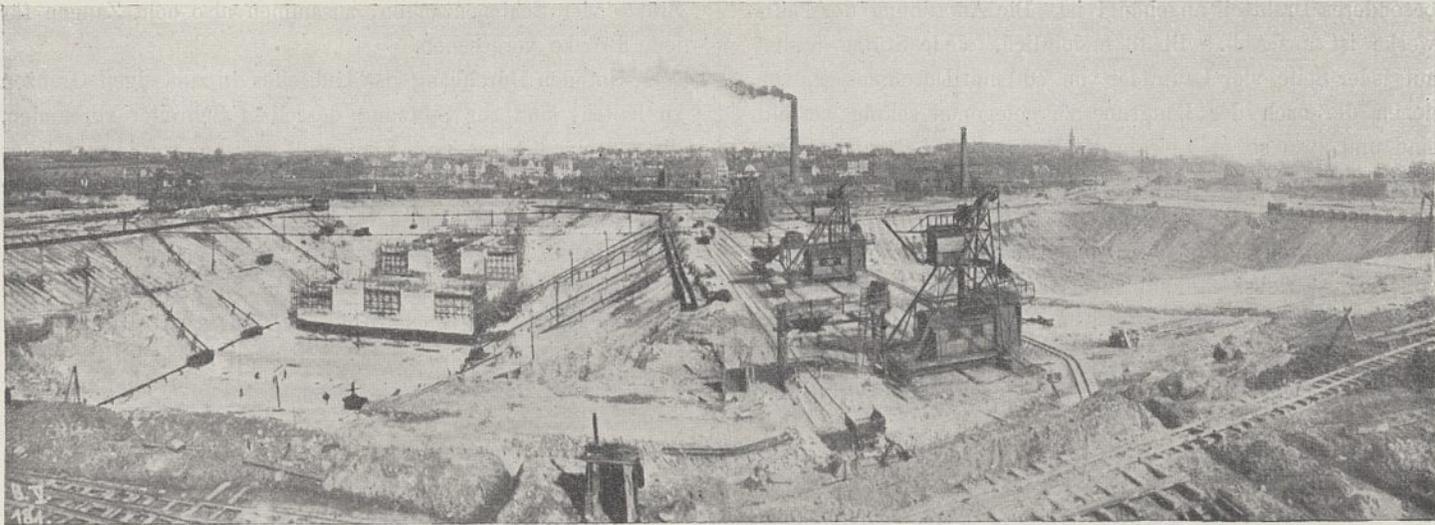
Baugruben des ersten und zweiten Bauabschnittes mit zwischenliegendem Damm.
